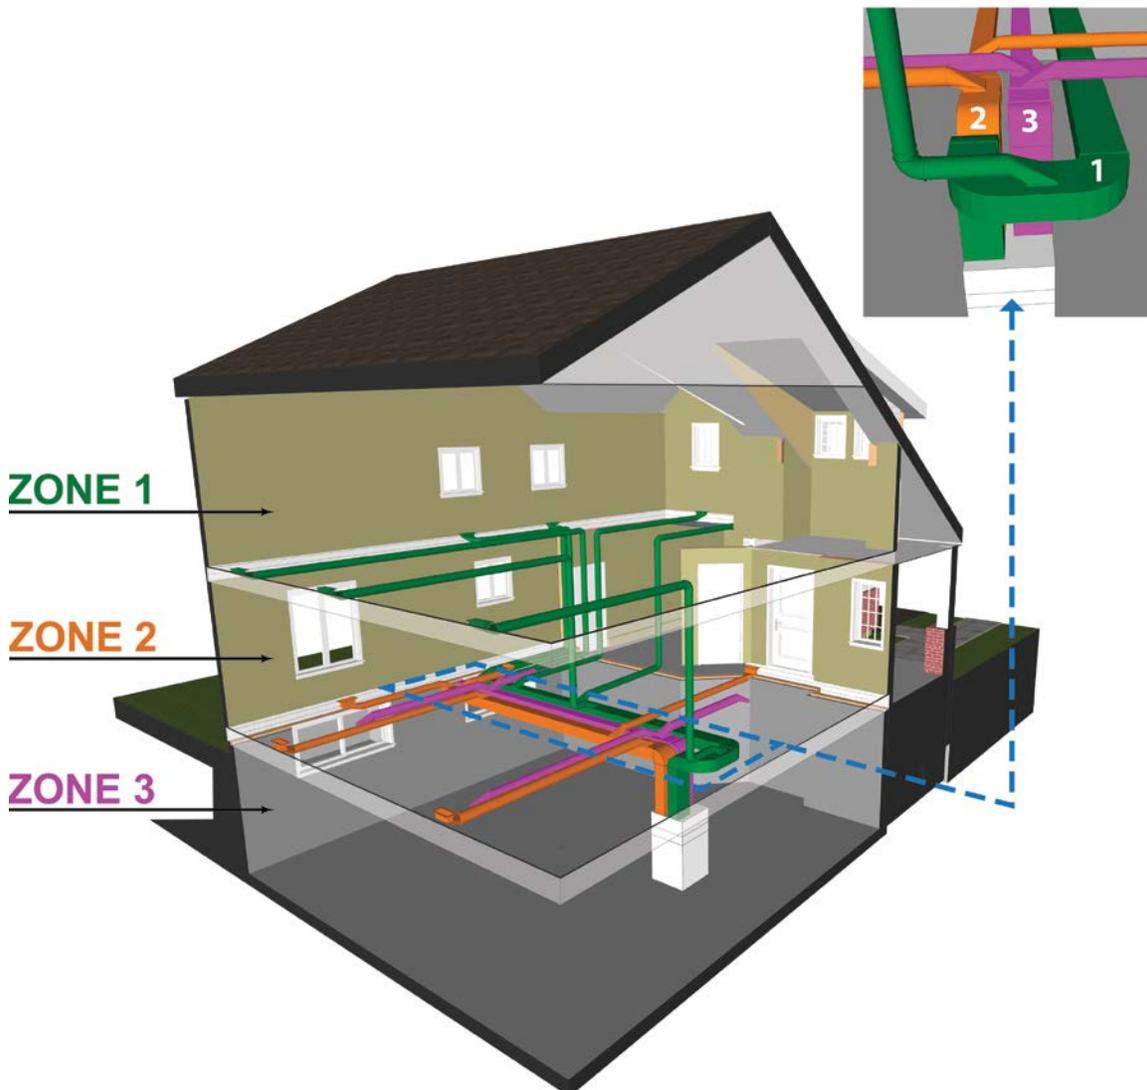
Exemple d'une conception de système de conduits d'air d'alimentation zoné avec trois conduits d'alimentation, un pour chaque étage d'une maison à deux étages avec sous-sol et un gros plan pour montrer les plénums zonés.
